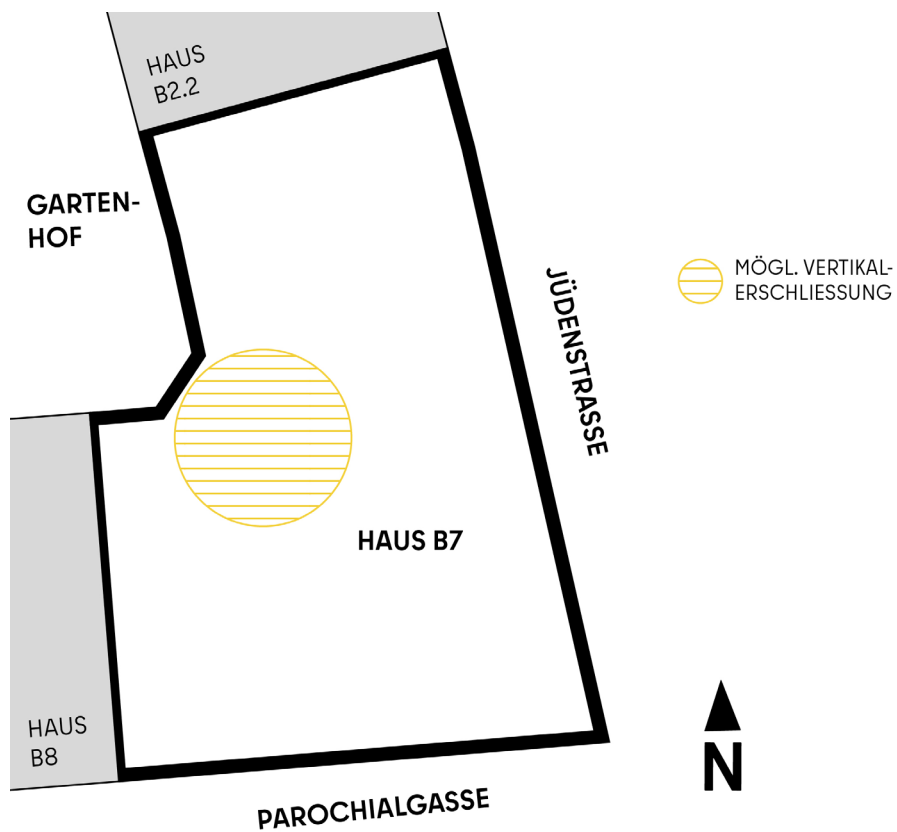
Schematischer Grundriss Untergeschoss
